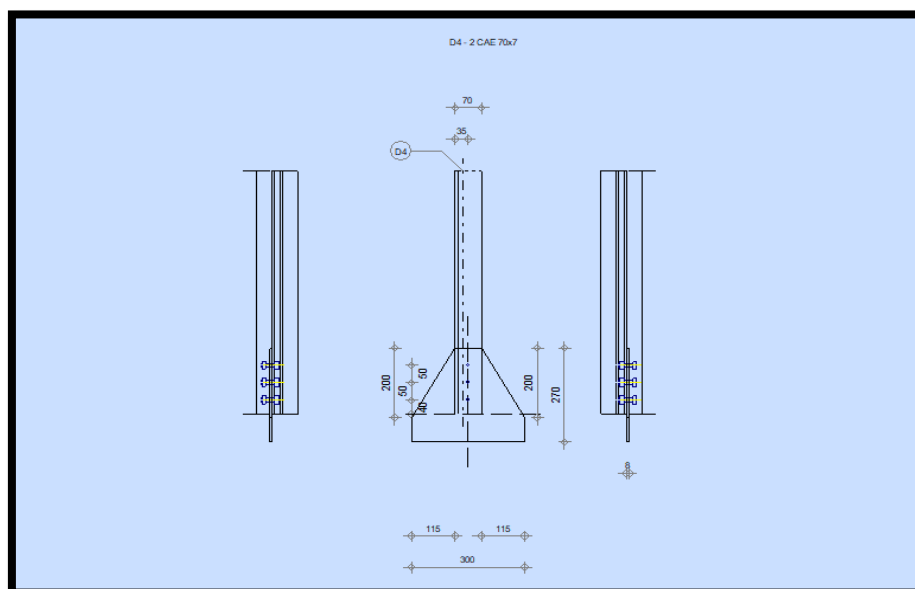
détails sur l'assemblage au gousset - deux barres
